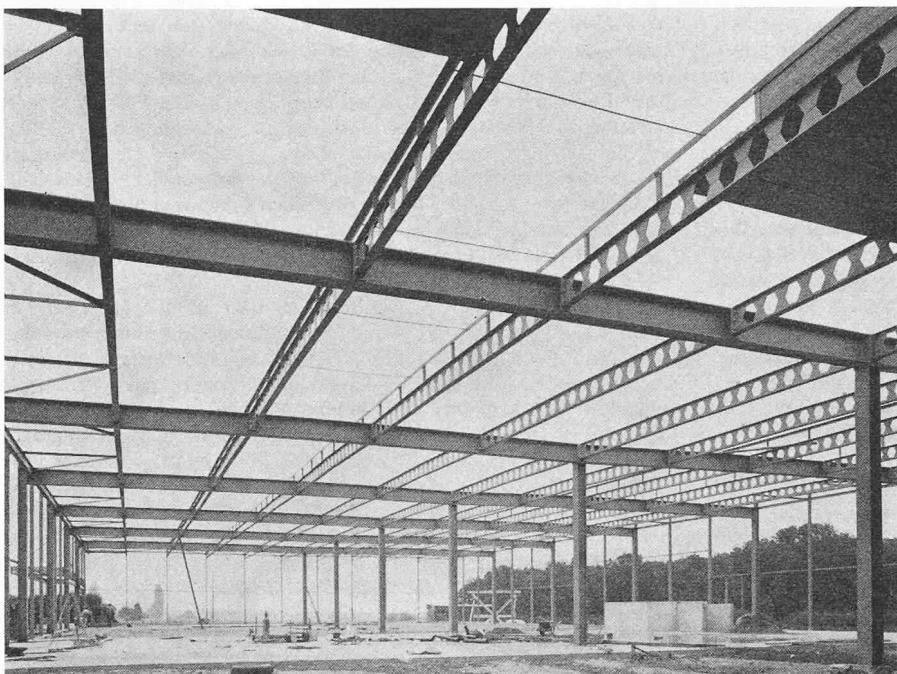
Flachdachhalle mit typisiertem Tragsystem
